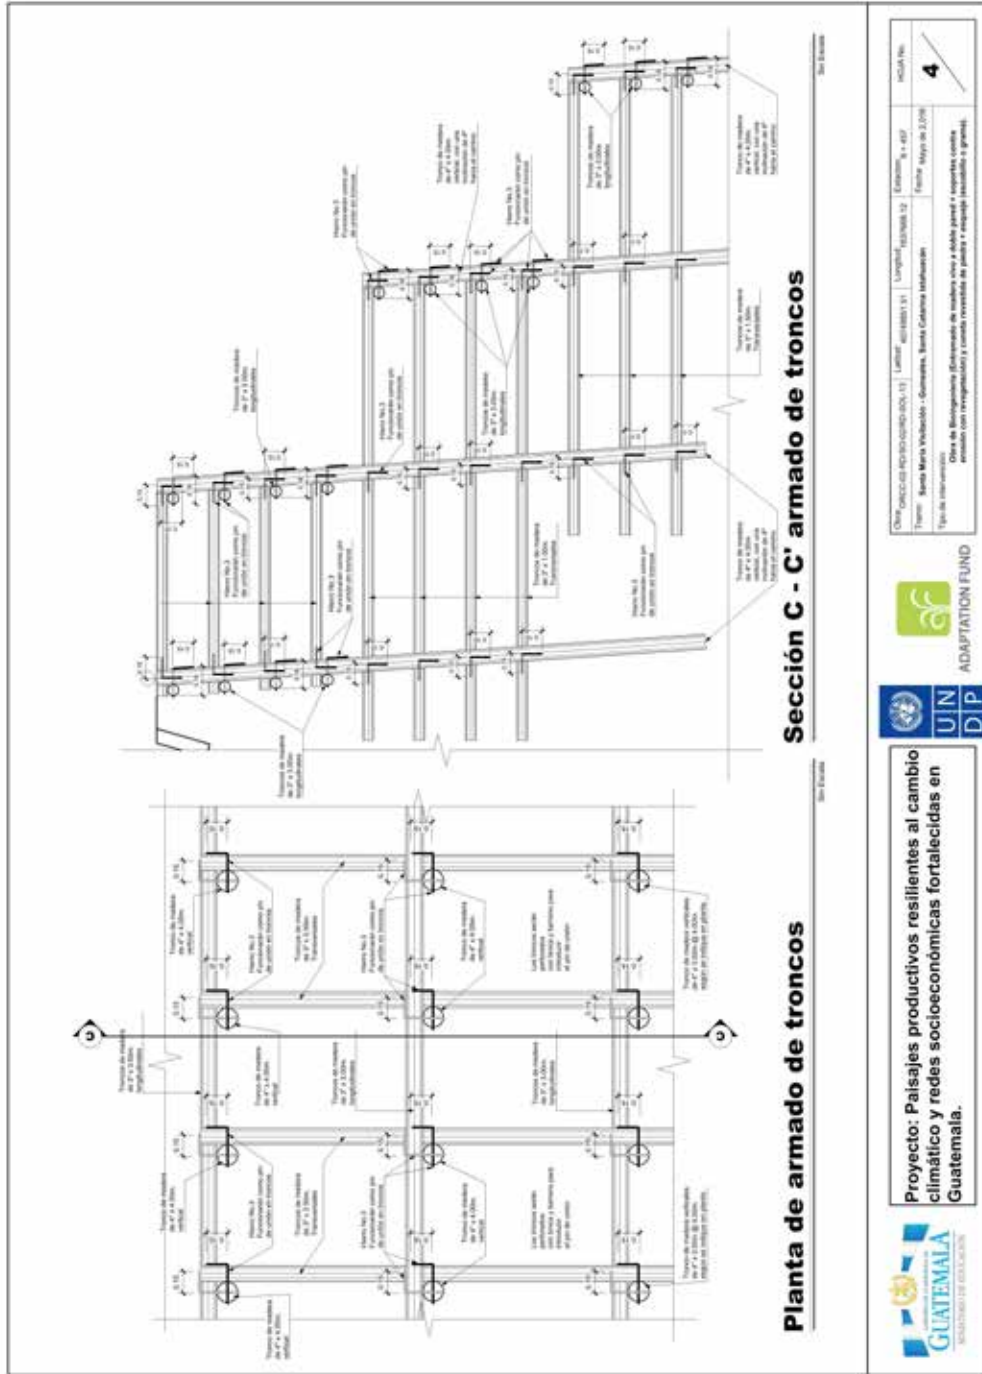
A. PLANTA DE ARMADO. SECCIÓN C-C'. Planificación Obra ORCC-02/RD-SOL-02 y RD-SOL-13. Tramo: (CA-01 Occidente/ KM-163-Cruz Bé/Bifurcación Santa María Visitación)
